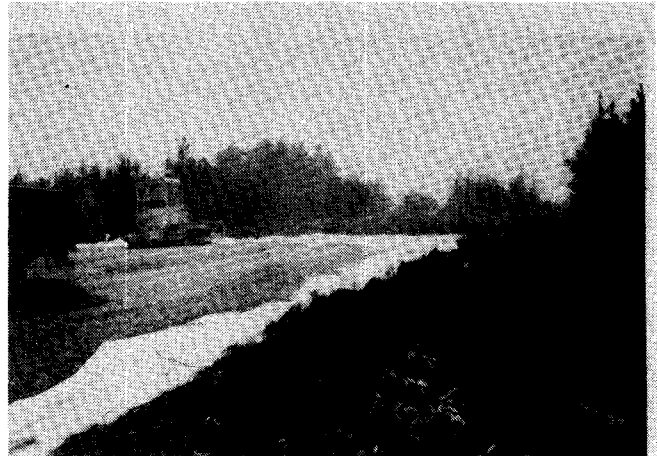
Straßenbau (Straßenunterbau Meathop-Sampool Bridge, GB)
